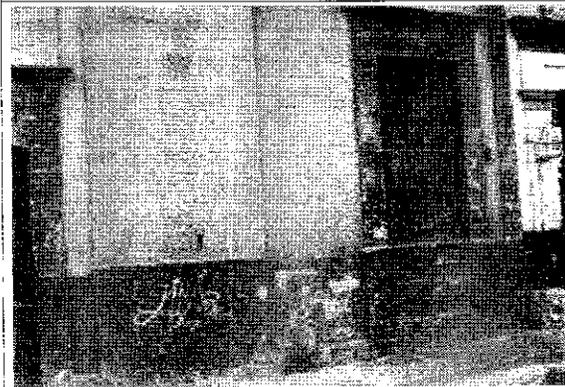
Deterioro en los acabados de la parte inferior del muro.
